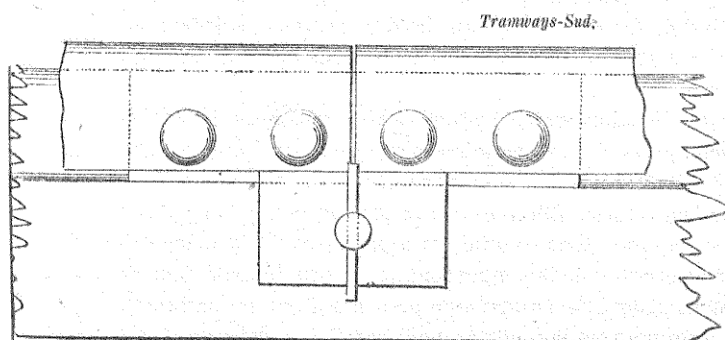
Élévation d'un joint des rails. Échelle 1/4.
